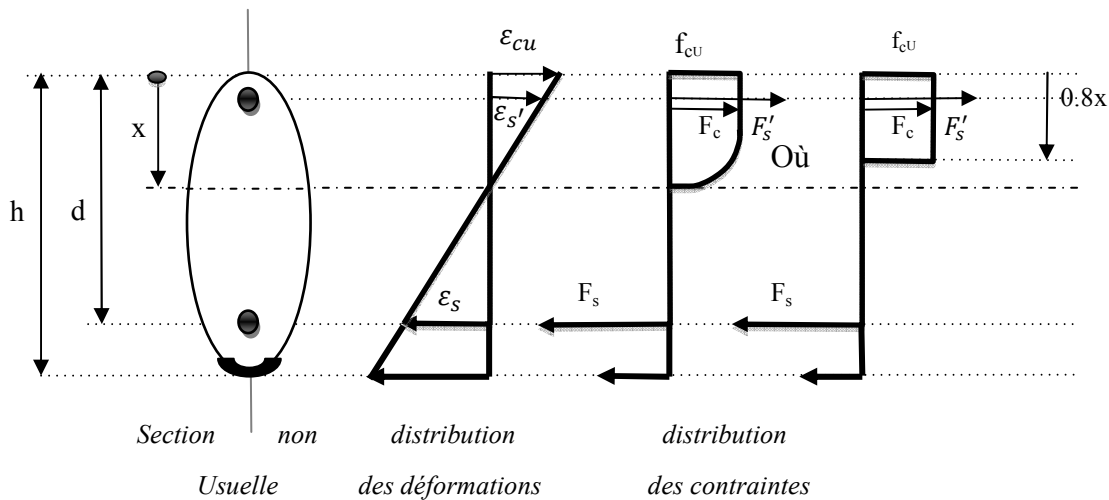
III.1 : Image à l'E.L.U d'une section non usuelle en béton armé renforcée. [9]
